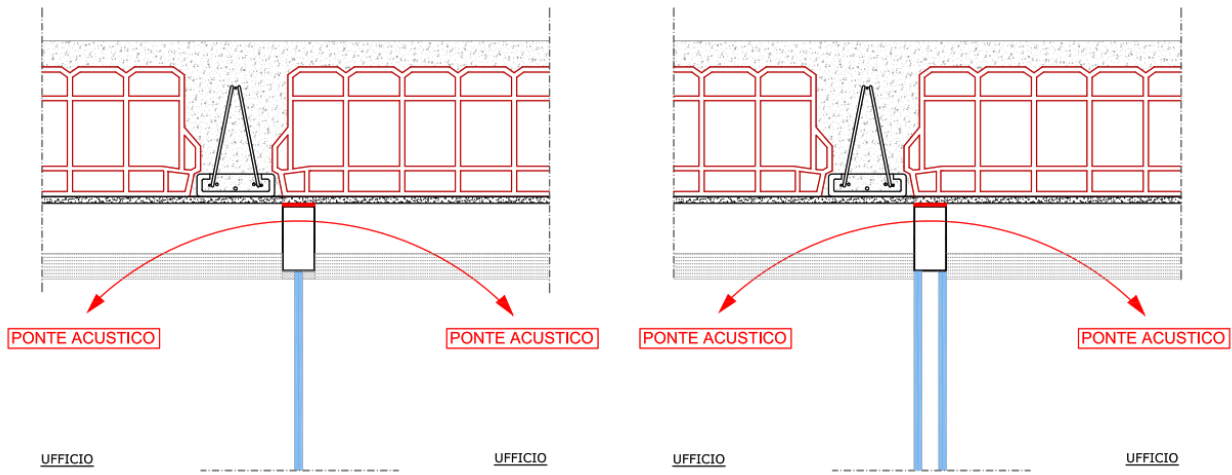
Sezione verticale. Trattamento del ponte acustico tra strutture verticali e orizzontali (solaio + controsoffitto e parete vetrata)
